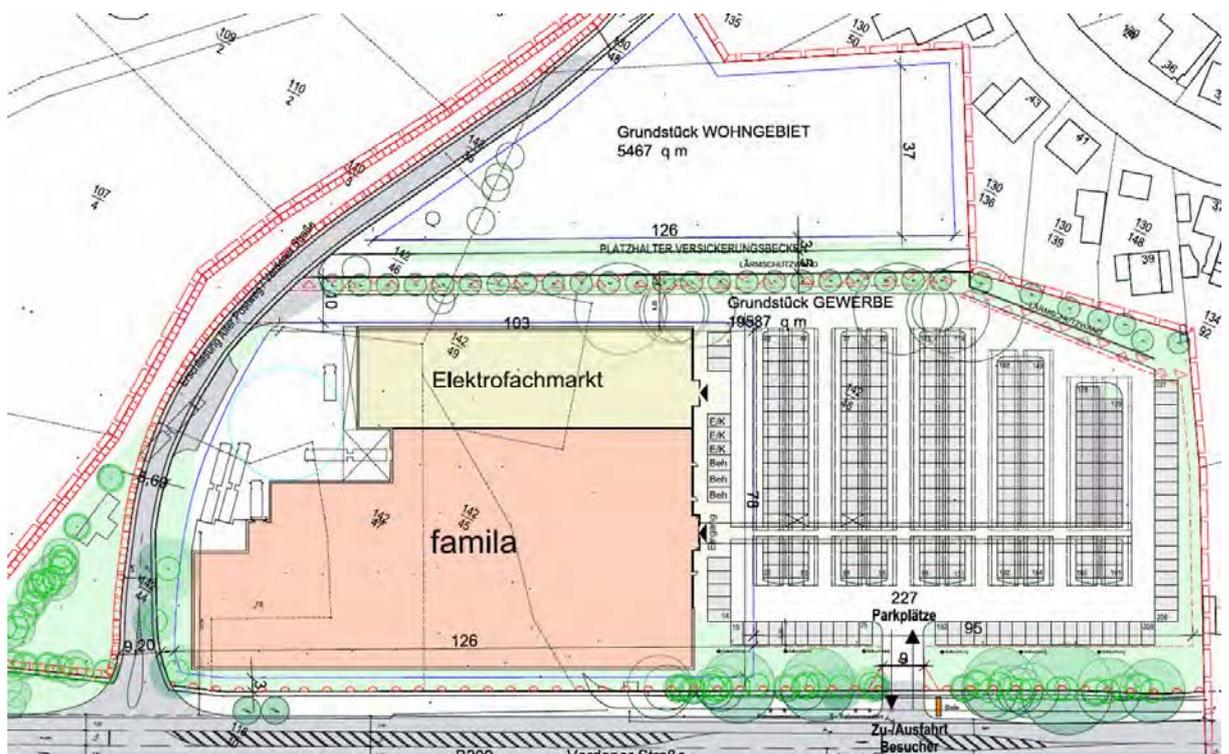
Lageplan Einzelhandelsstandort (*familia*)
